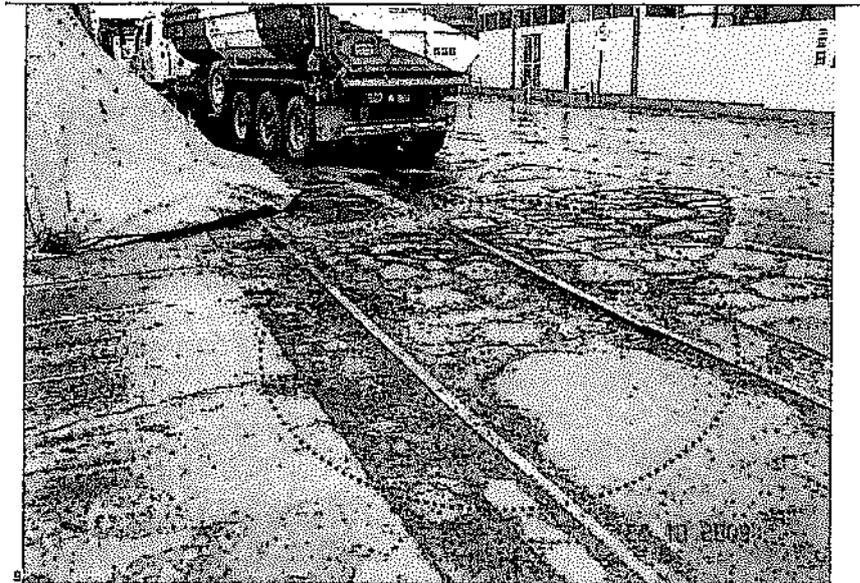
(Obs.1, 2009) : Losas deterioradas frente a oficinas administrativas en los rieles.
